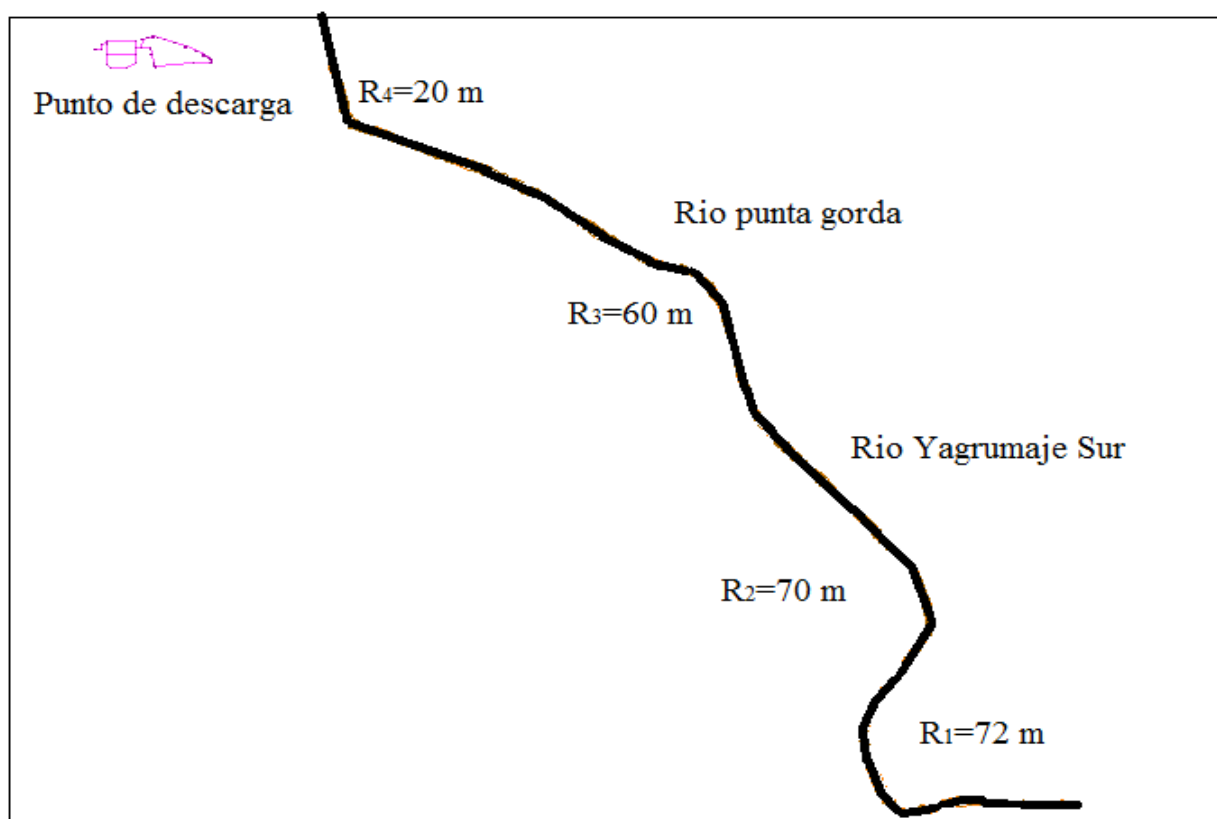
Perfil del camino minero empleado en el transporte de las menas lateríticas mullidas de la UBMECECG. Vista en planta.
